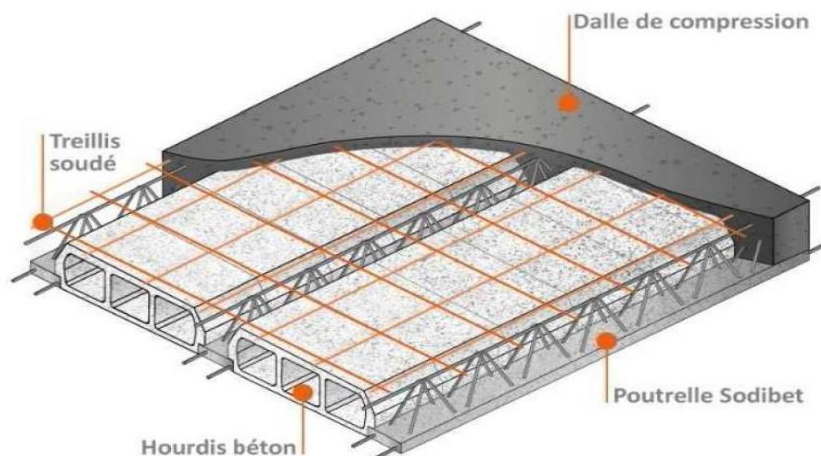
coupe transversale d'un plancher en corps creux.
